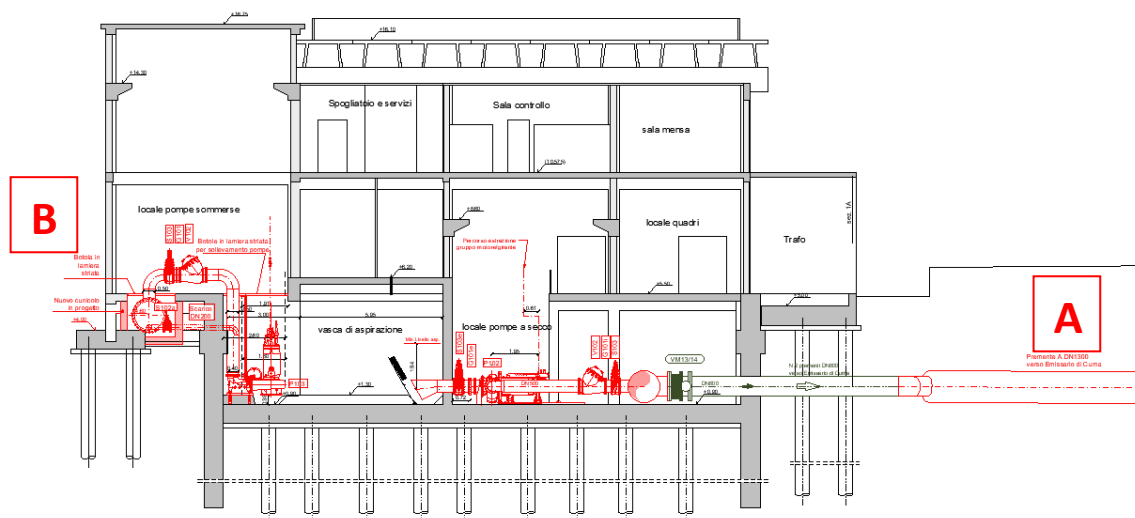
Sollevamenti all'emissario di Cuma – Sezione A-A – Stato di progetto
